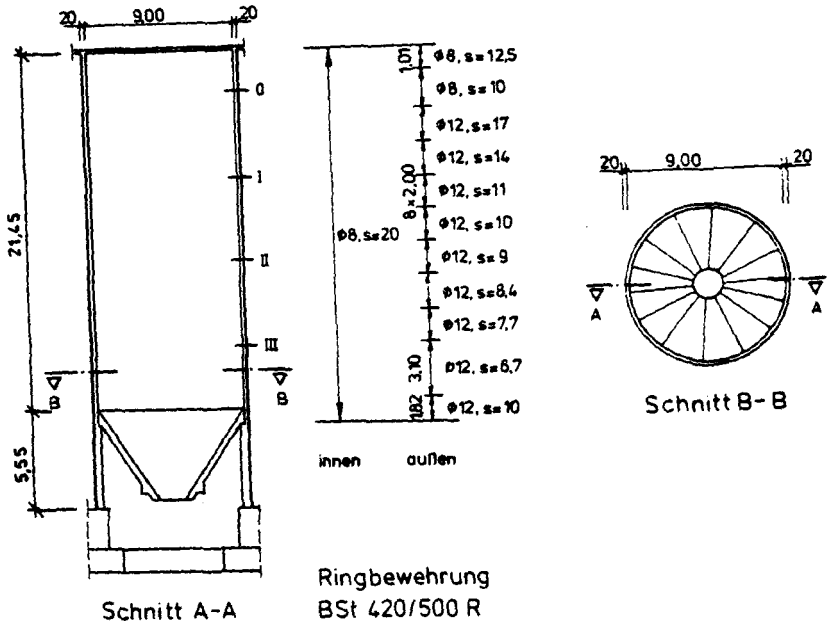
Schnitte und planm. Ringbewehrung
